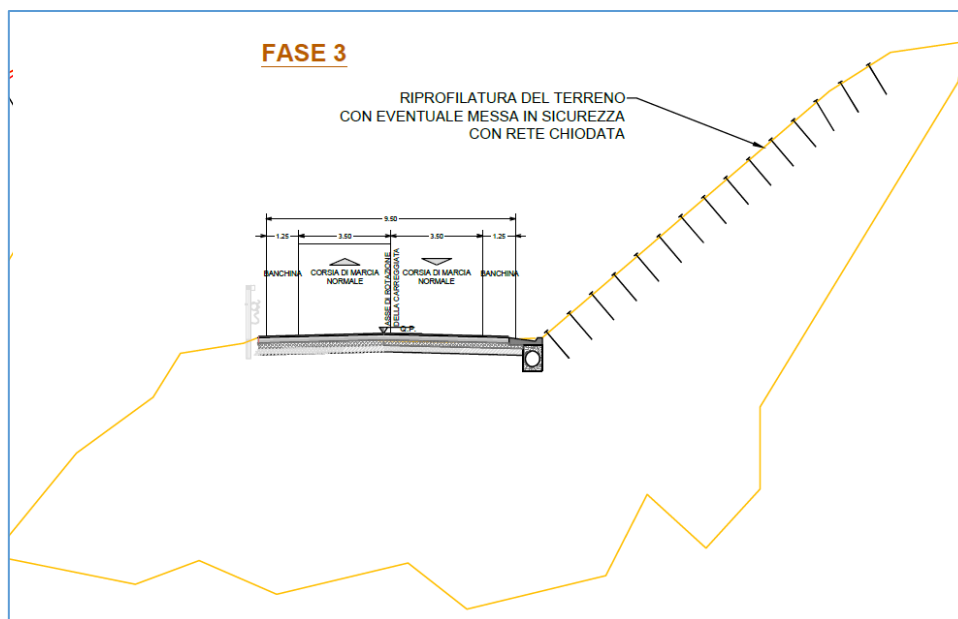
d – Sezione tipo 4 – Post Operam
